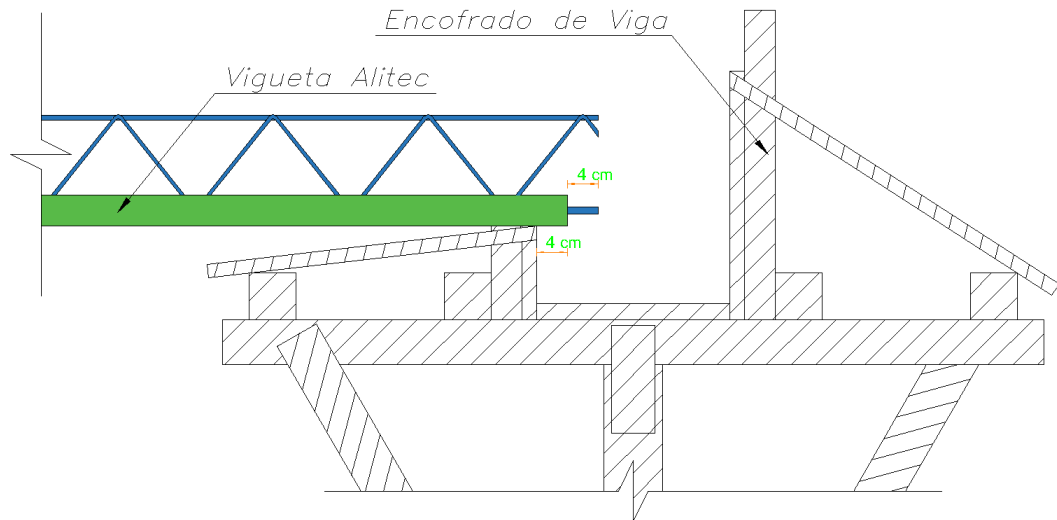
Detalle del Apoyo de la Vigueta Alitec, en Vigas, Placas y Muros Portantes.
